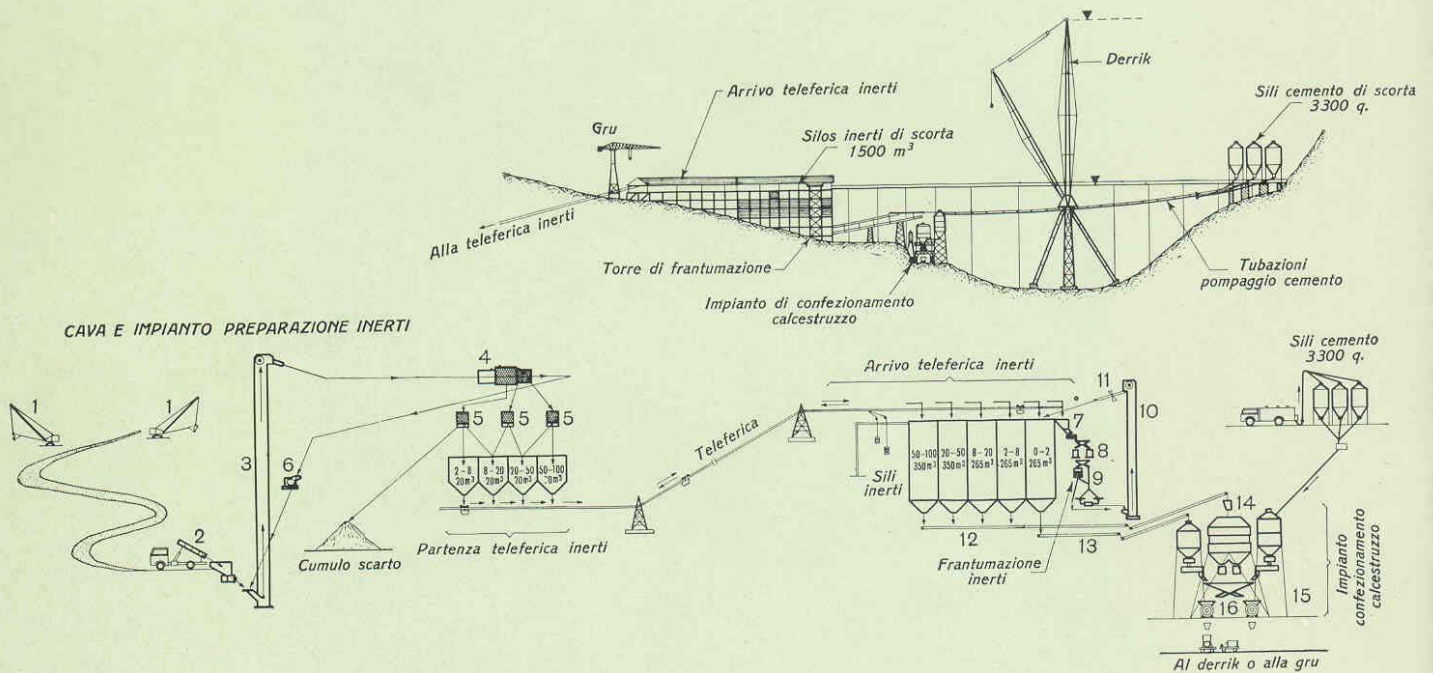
DIGA DI CASOLI — Impianti per la lavorazione degli inerti e la confezione del calcestruzzo. Schema delle installazioni.
